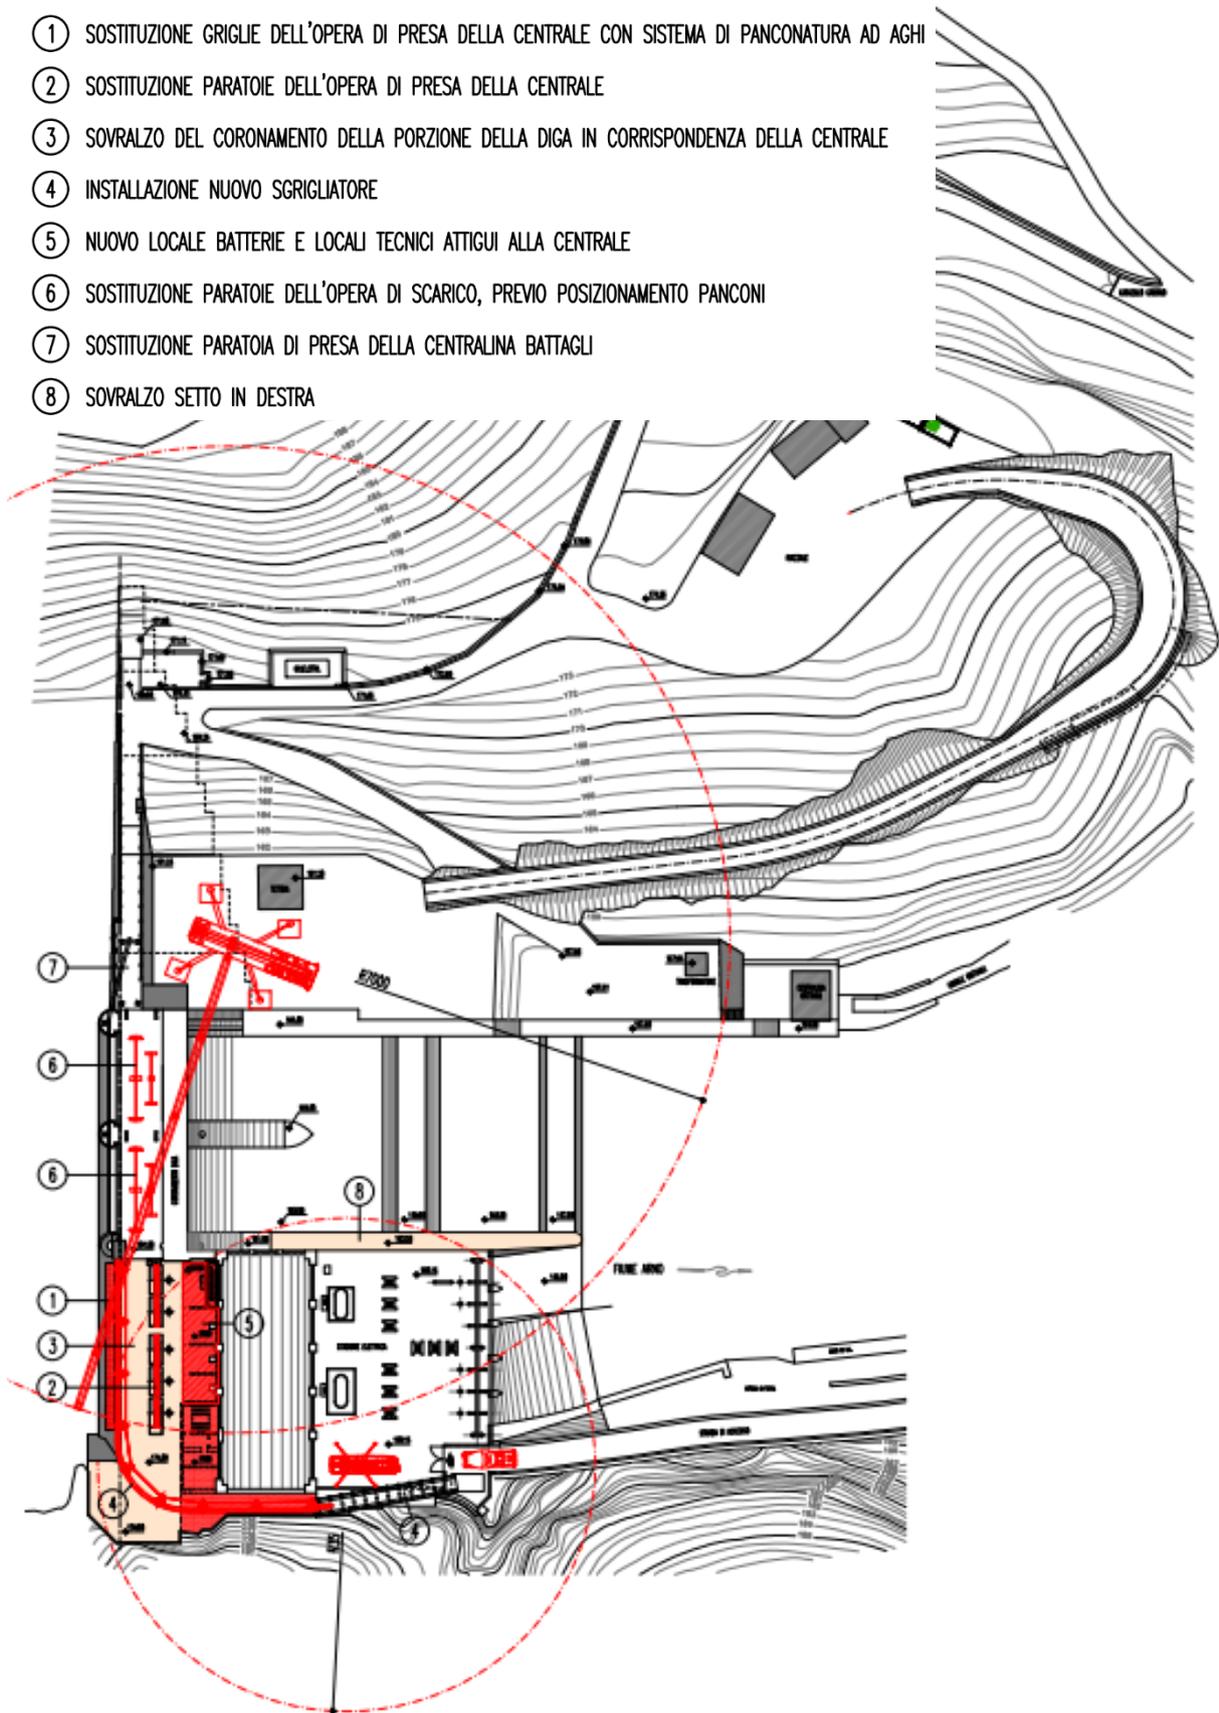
2 – Estratto planimetrico elaborato progettuale – Cantierizzazione FASE2
